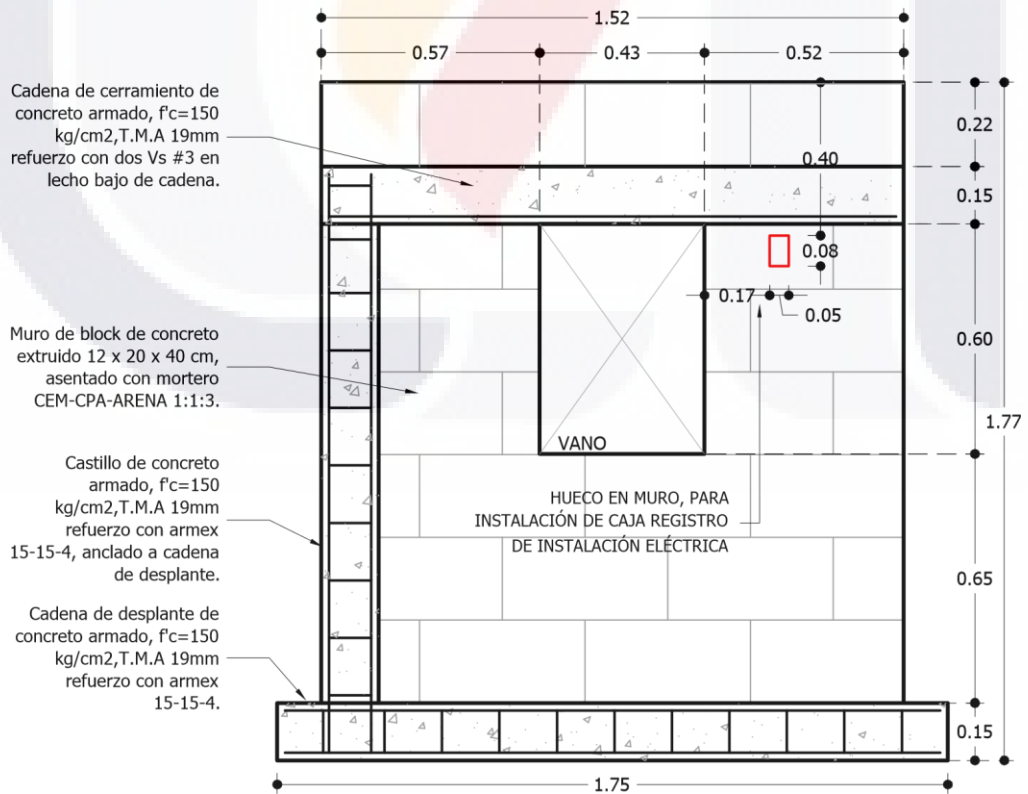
Detalle constructivo de diseño de MBC 2 Cara B
